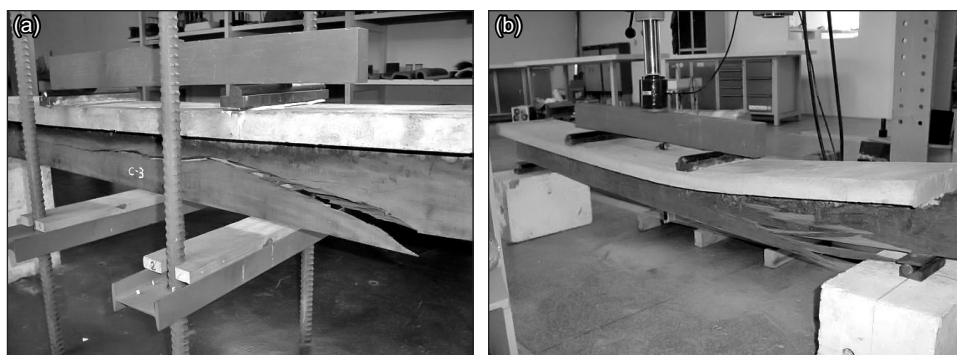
Ruptura nos pontos de aplicação da força nas vigas mistas: a) viga 7 e b) viga 11.
